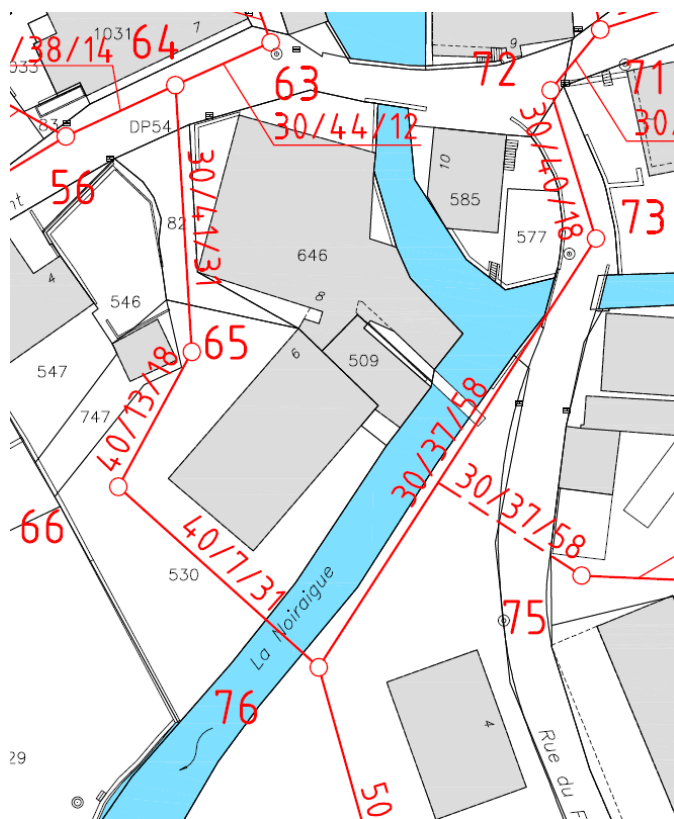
extrait du PGEE de la Commune de Noiraigue (Canalisations existantes, plan 1047-02)
